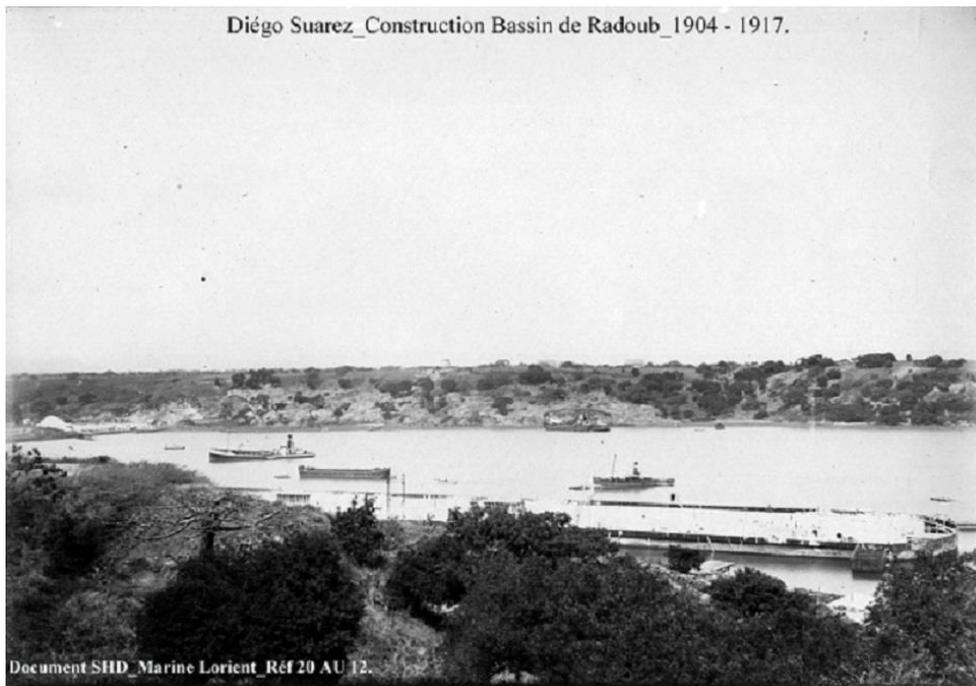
Construction des maçonneries en pierres de taille (Archives SHD Lorient). On peut remarquer le batardeau amovible de forme arrondie qui ferme le caisson.
